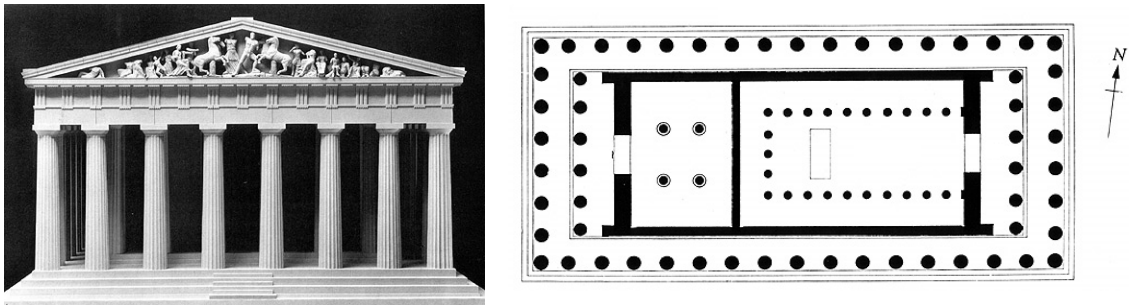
e 209 Fachada principal do Parthenon e planta térrea (Atenas, Grécia) [Shaw, 2000] [159]
